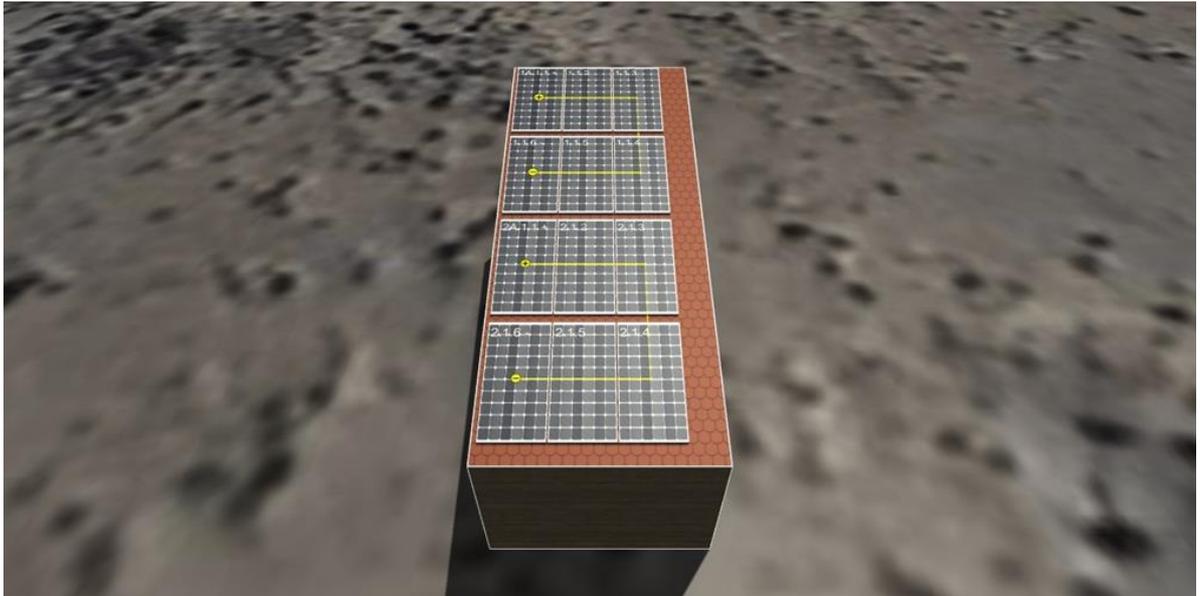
Figura C - Distribución de Paneles FV Techo Vivienda Tipo Vista 3d
